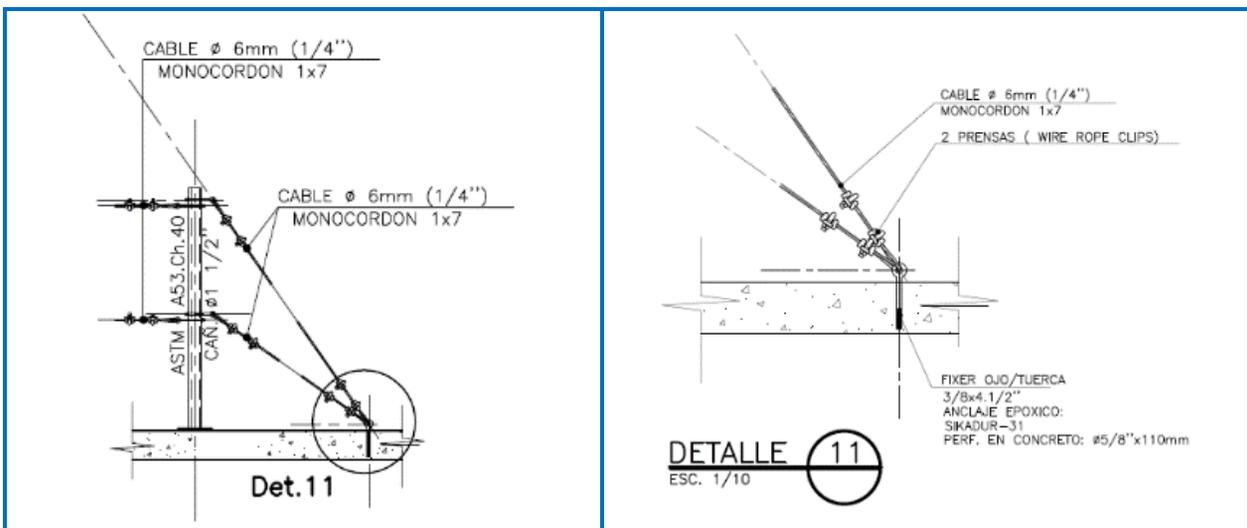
Sistema de protección conectable anclado a una losa estructural (medidas en cm)- Elaboración Propia
